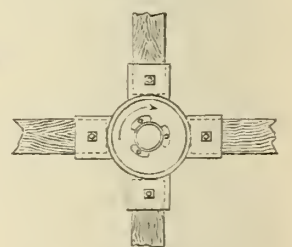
Nabe des Haspels zum Einschrauben d. Pfähle. Grundriss.
